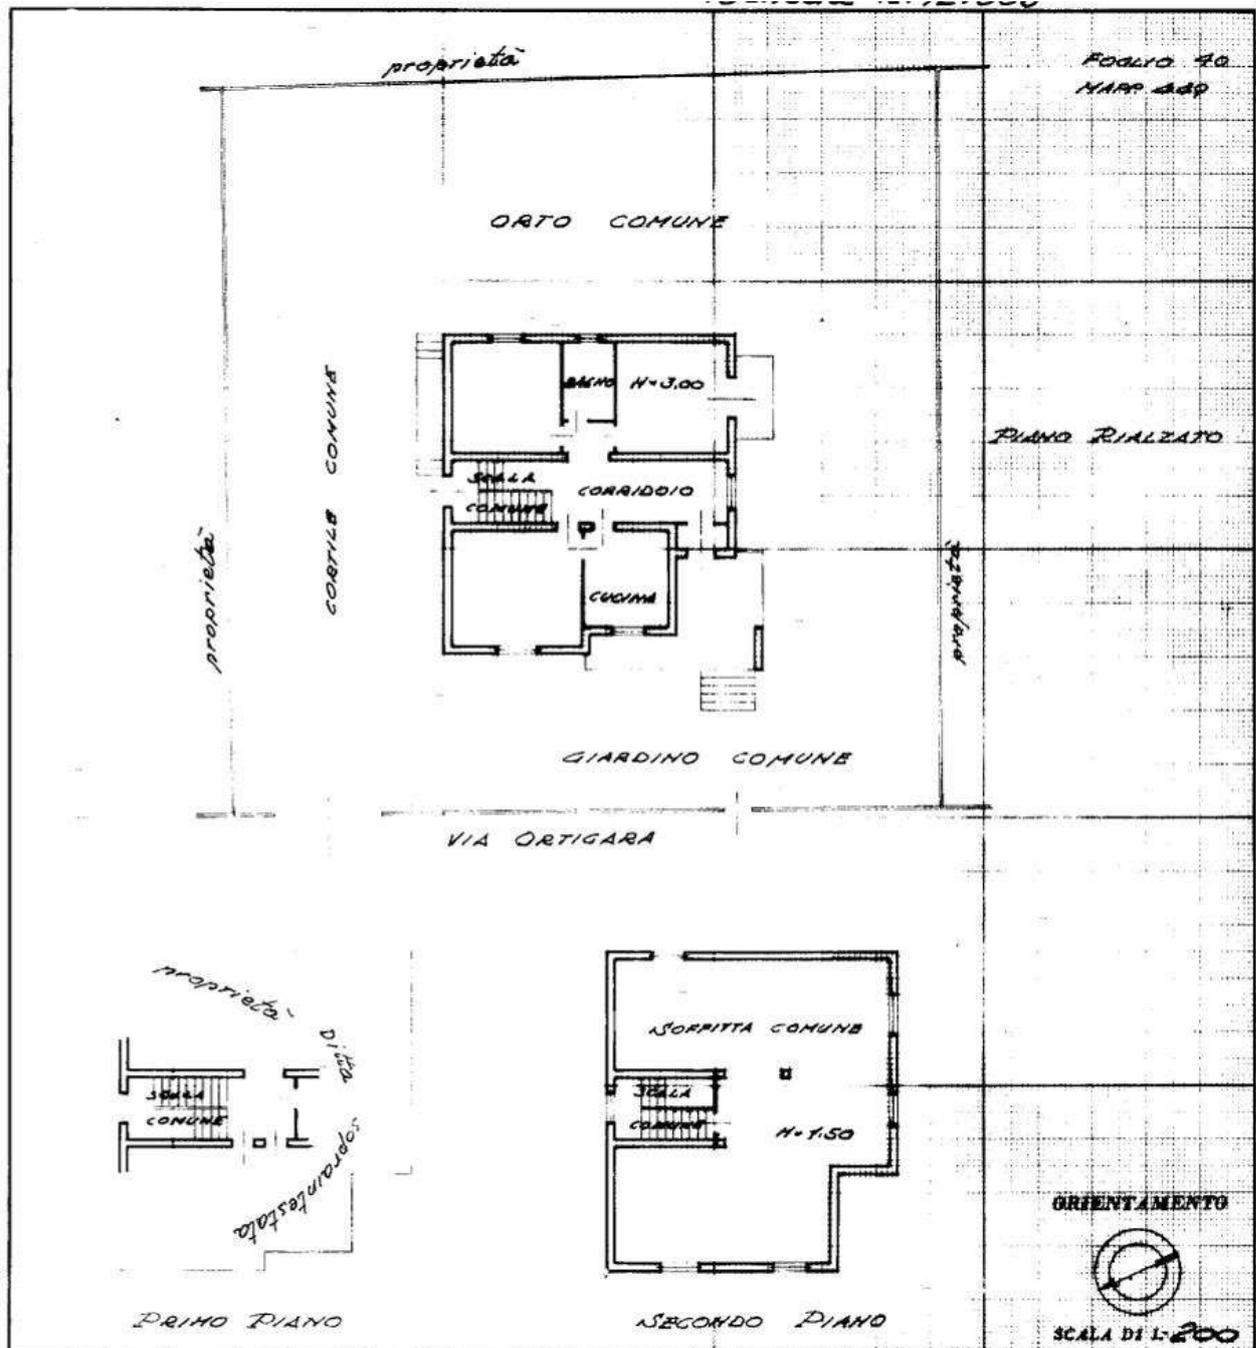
Estratto planimetria catastale Part. 449 sub. 2
